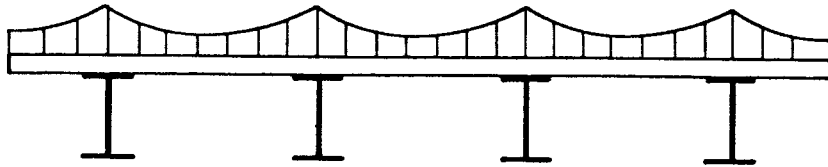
TENSÕES LONGITUDINAIS NA LAJE DEVIDO AO EFEITO " SHEAR LAG "
